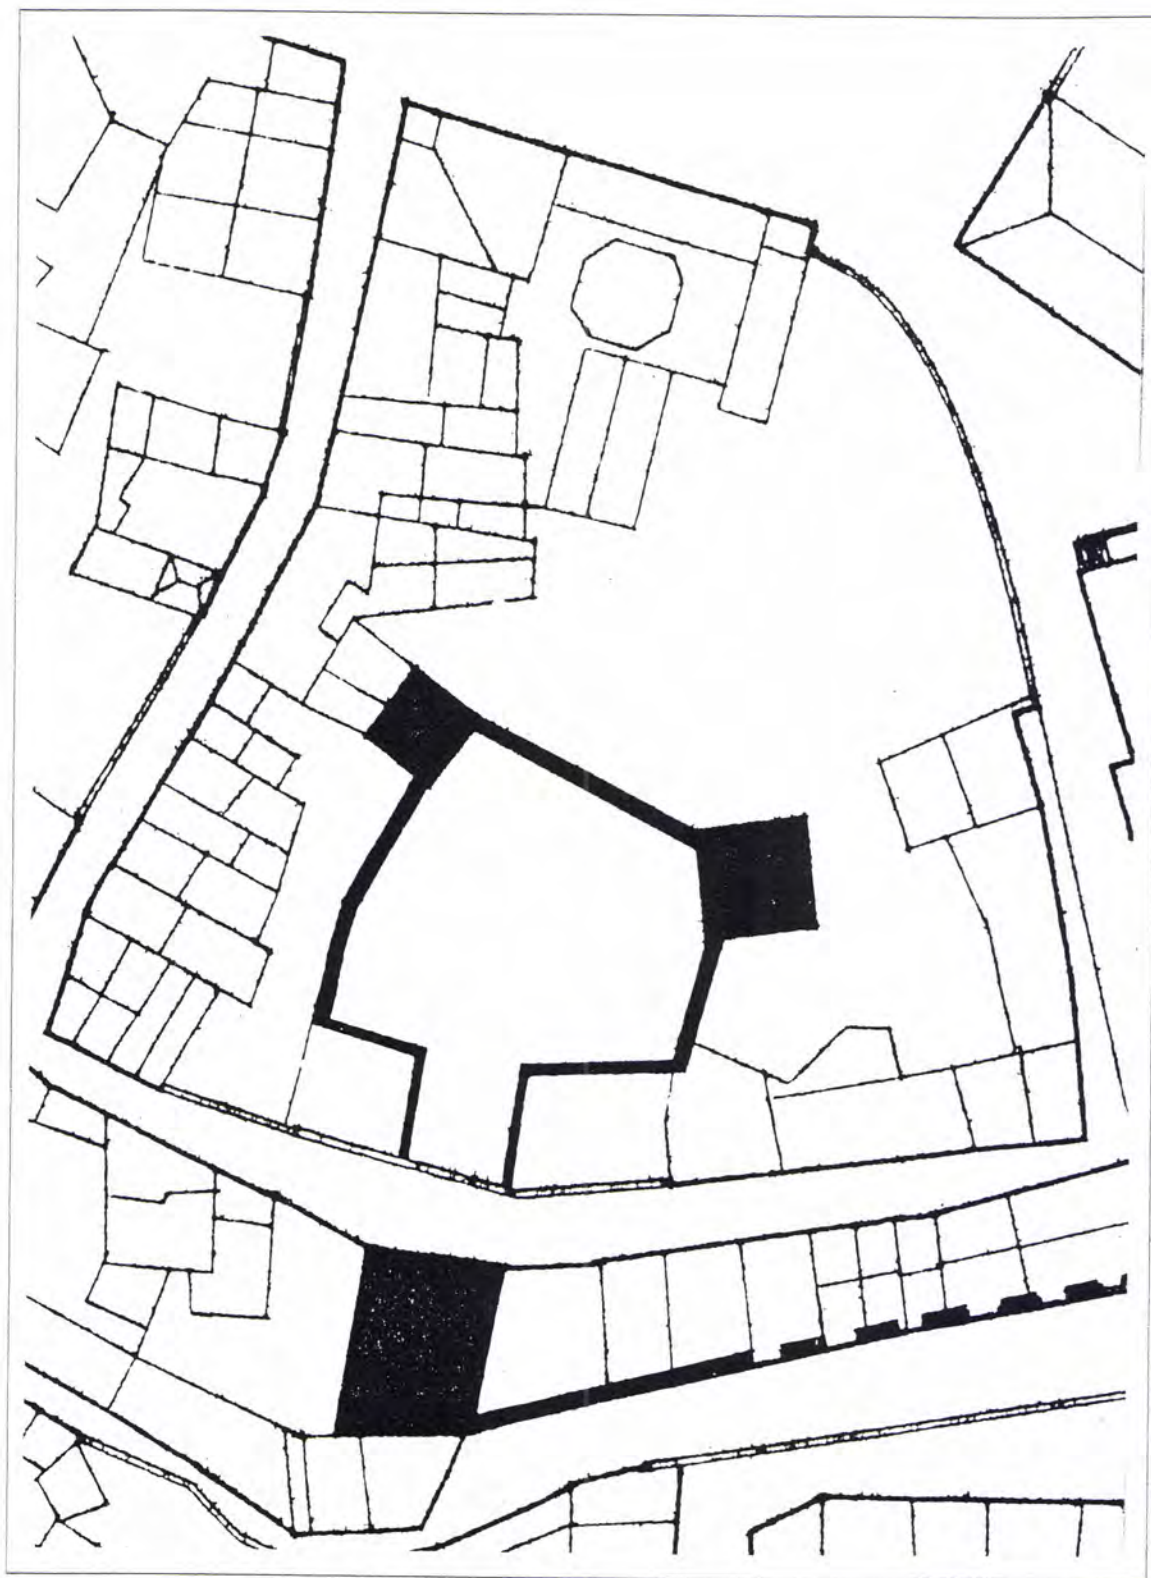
Portalegre. Planta do castelo (desenho DGEMN)
